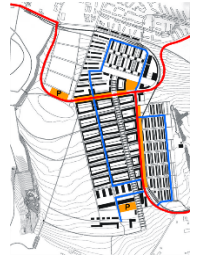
Hauptverkehrsstraße, Schnitt / Lageplan, Eigene Darstellung 2020
